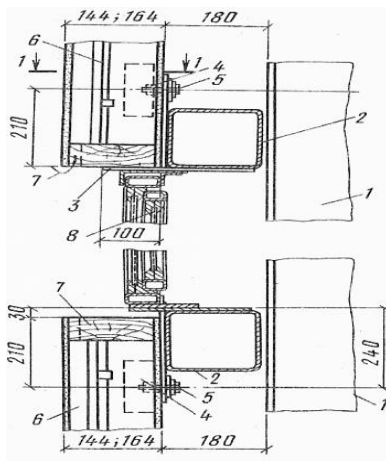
Сопряжение асбестоцементных каркасных панелей с окном: 1 – колонна каркаса; 2 – стальной ригель; 3 – стальной опорный столик; 4 – стальной закладной уголок; 5 – болт; 6 – стеновая панель; 7 – продух; 8 – окно со стальными переплетами
